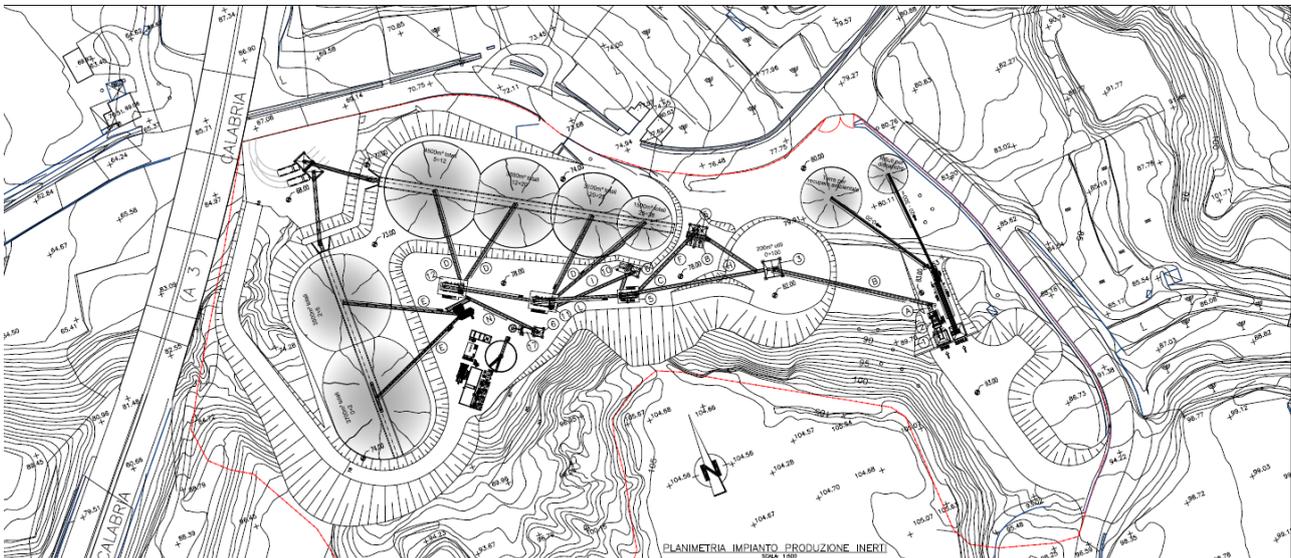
Estratto dalla tavola CZV0144_FO - planimetria e layout impianto produzione inerti CC1
